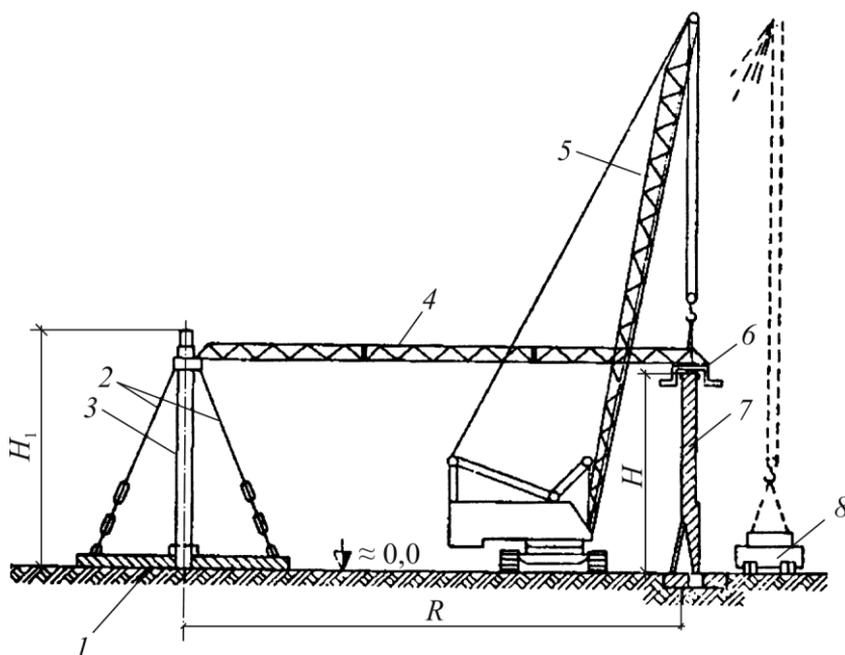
Схема подвижного кондуктора для монтажа железобетонных панелей опускного колодца: 1 – фундамент мачты кондуктора; 2 – растяжка; 3 – мачта; 4 – поворотная распорка; 5 – монтажный кран; 6 – опорная часть конструкции; 7 – железобетонная панель; 8 – панелевоз
